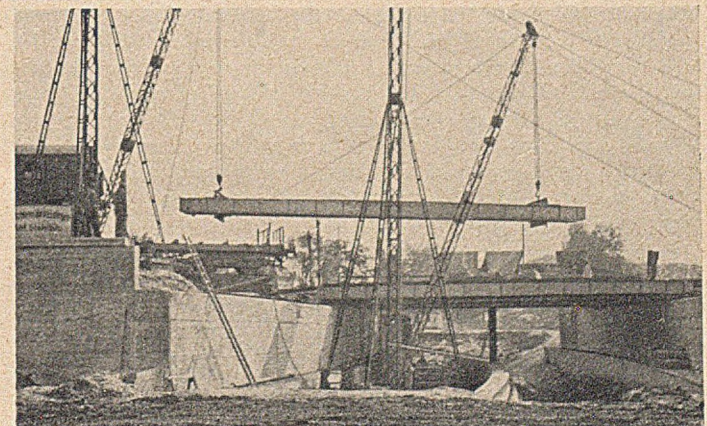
Eisenbahnbrücke über die Straße nach dem Güterbahnhof Heilbronn (Brücke 3). Einlegen eines geschlossenen Kastens des Überbaus.
